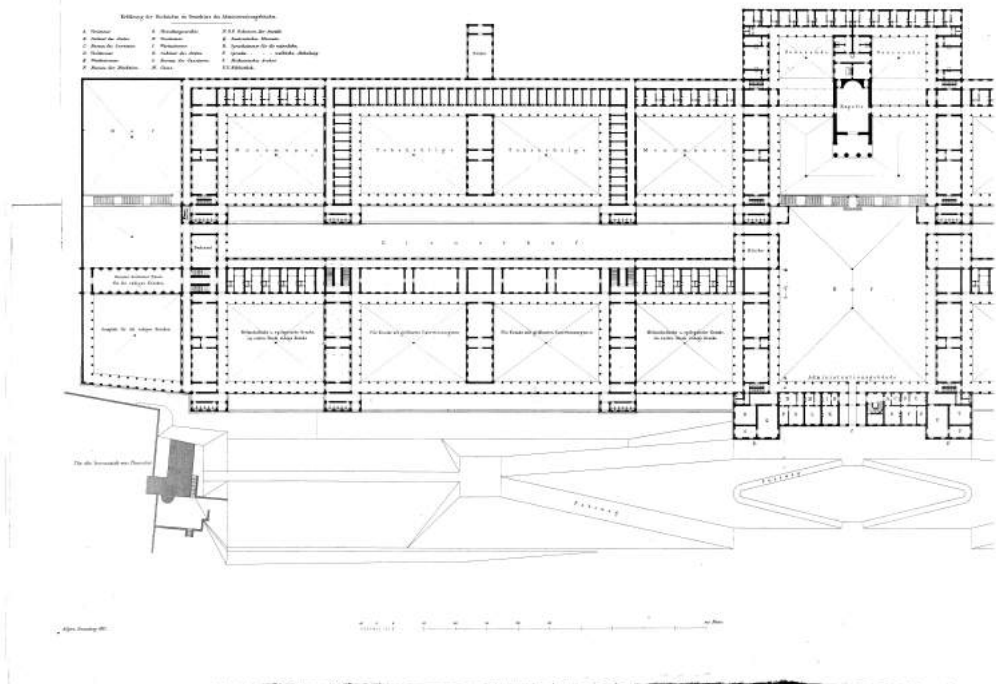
Irrenhaus zu Charenton bei Paris. Grundriss zu ebener Erde.
